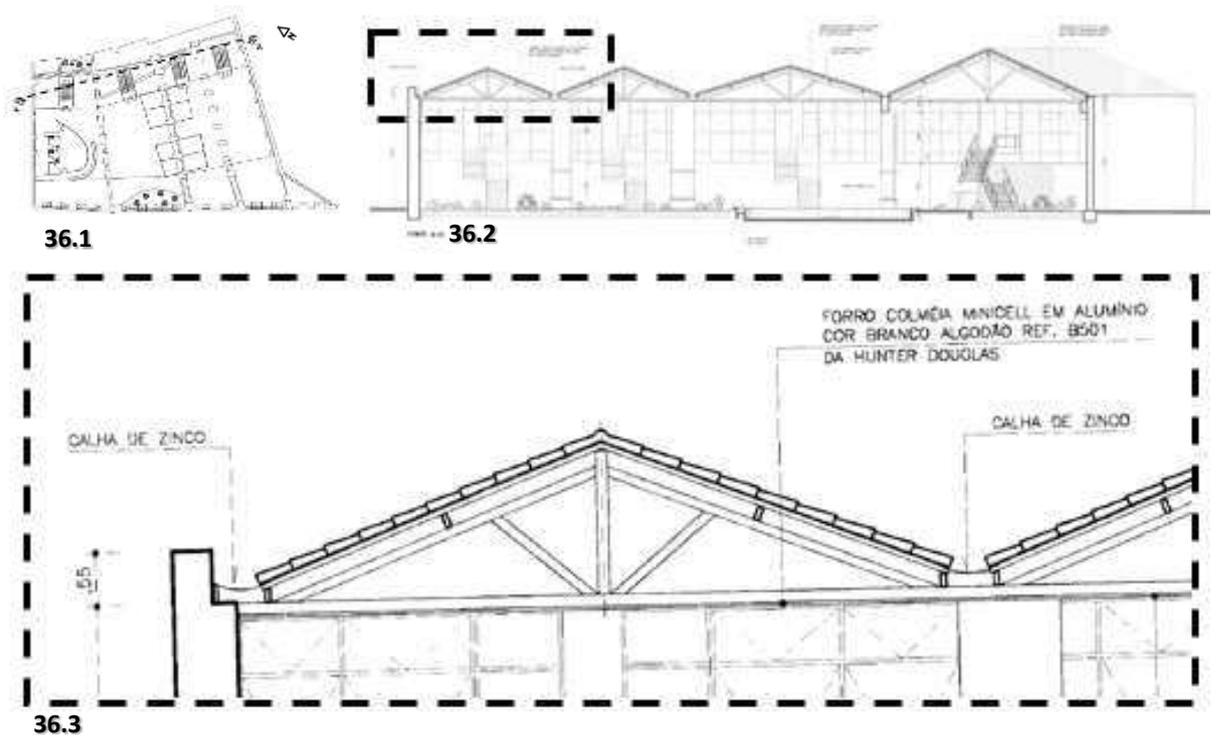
Detalhe da cobertura do prédio Morada das Artes (36.1 – Indicação do corte AA em planta baixa; 36.2- Corte AA com indicação de detalhe; 36.3 – Detalhe da cobertura)
